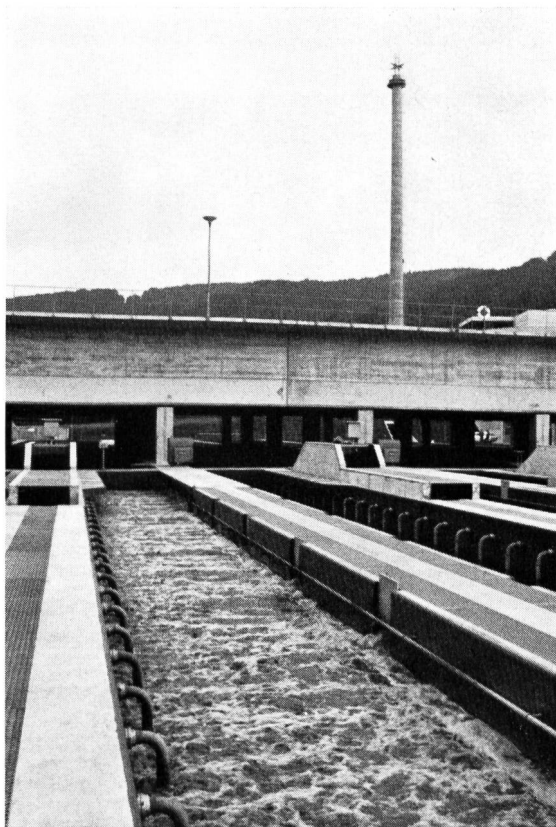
Blick auf die zweistöckige Kläranlage: Vorklärbecken im oberen Stock, im Vordergrund Belüftungsbecken.
